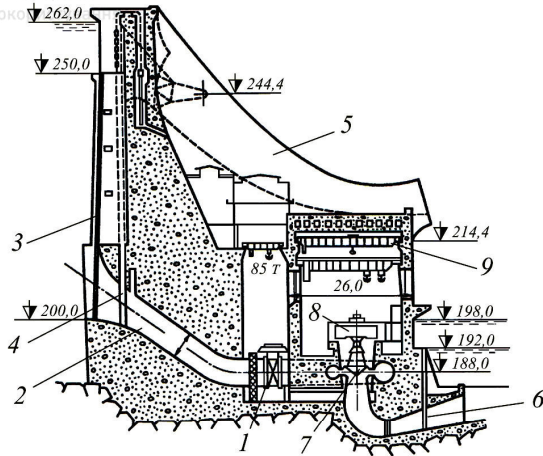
Поперечний переріз водозливної будівлі ГЕС:
